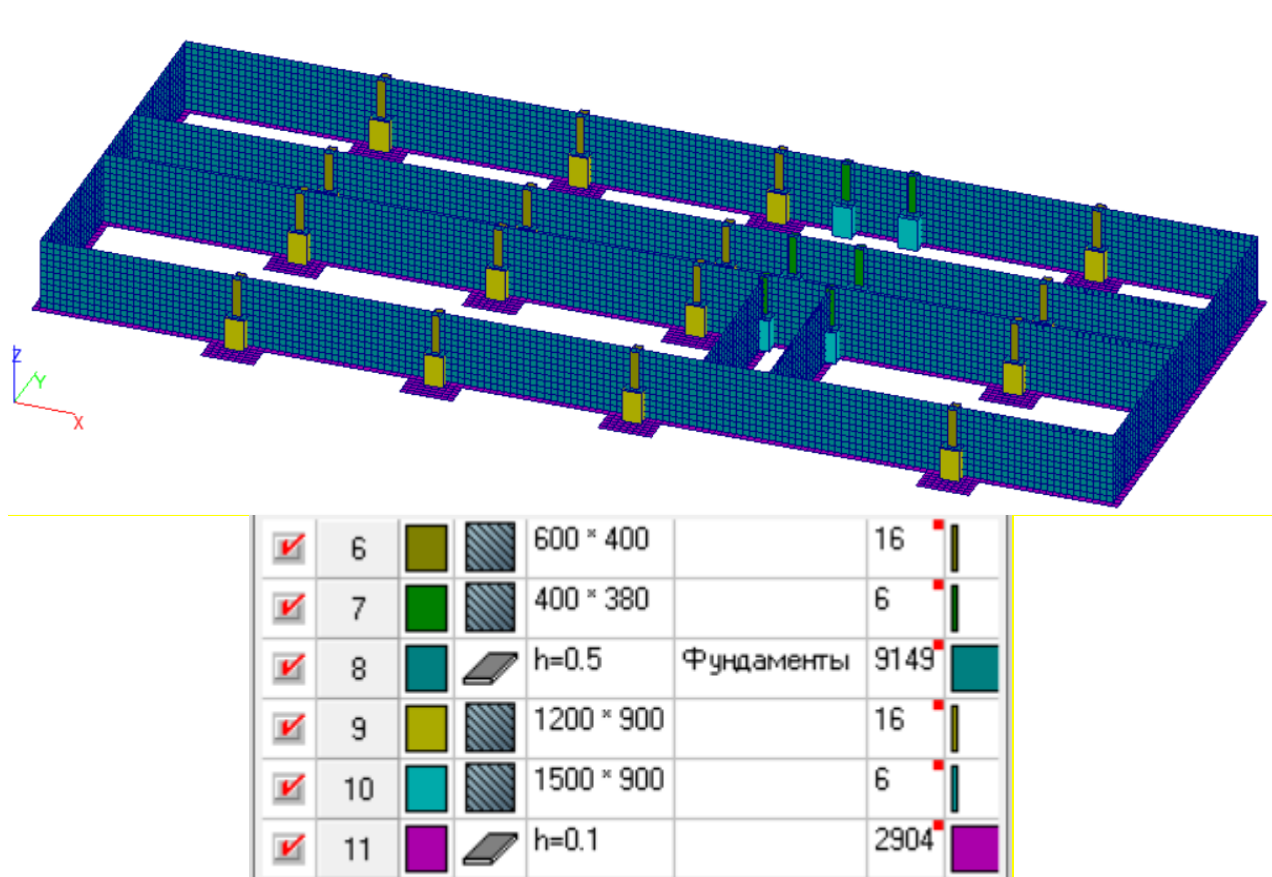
Фрагмент расчетной схемы (фундамент)
